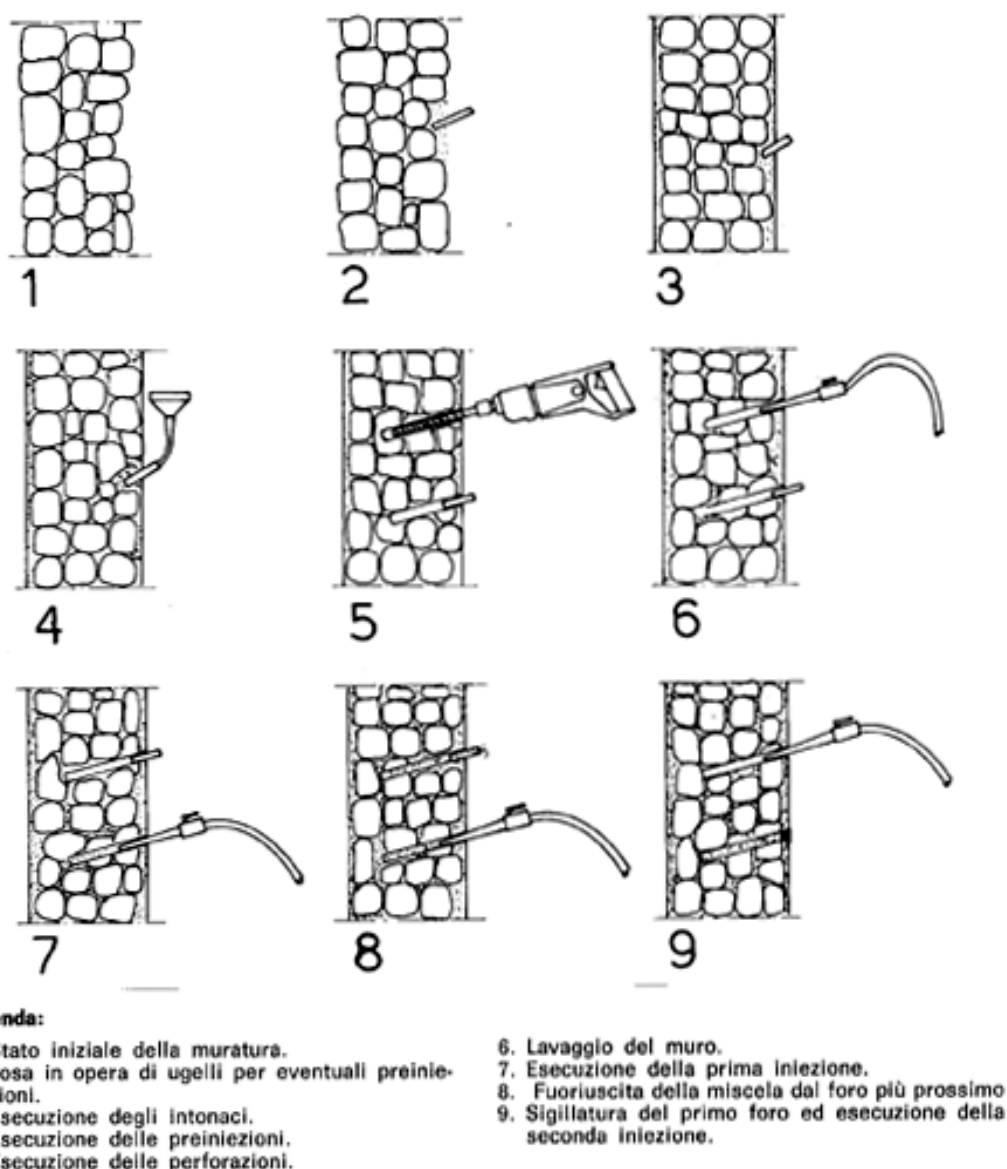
Fasi dell'intervento di consolidamento con iniezioni cementizie (3).
